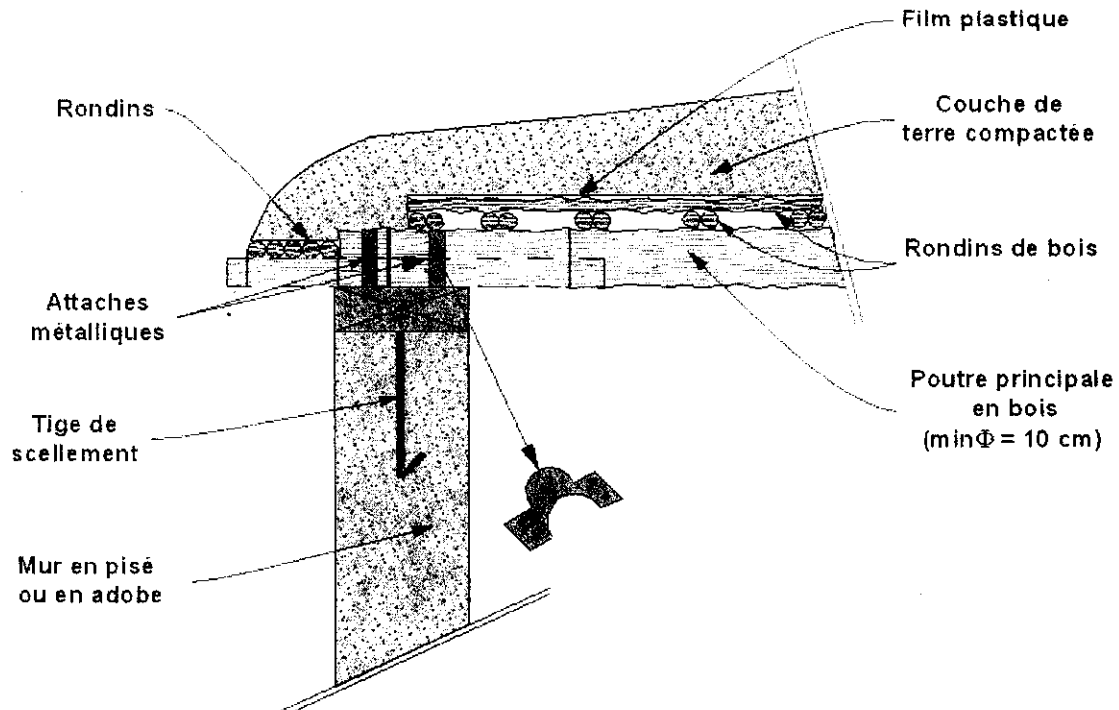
Chaînage et dispositif d'attaches d'une toiture débordante
